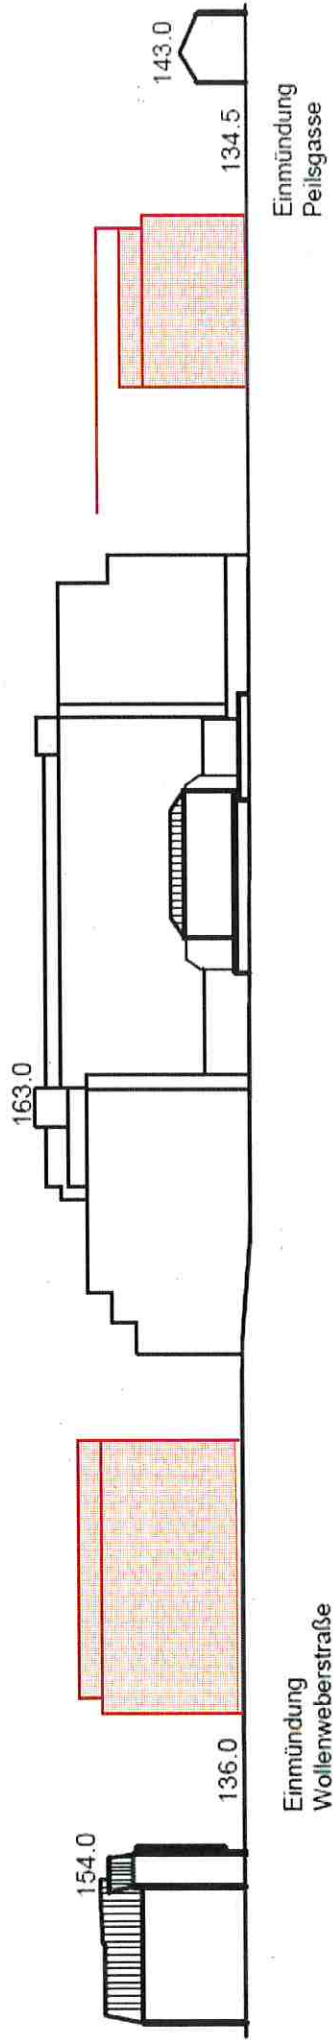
Schematische Fassadeabwicklung Indestraße, Höhenangaben näherungsweise in m ü NHN [Quelle: Stadt Eschweiler]
